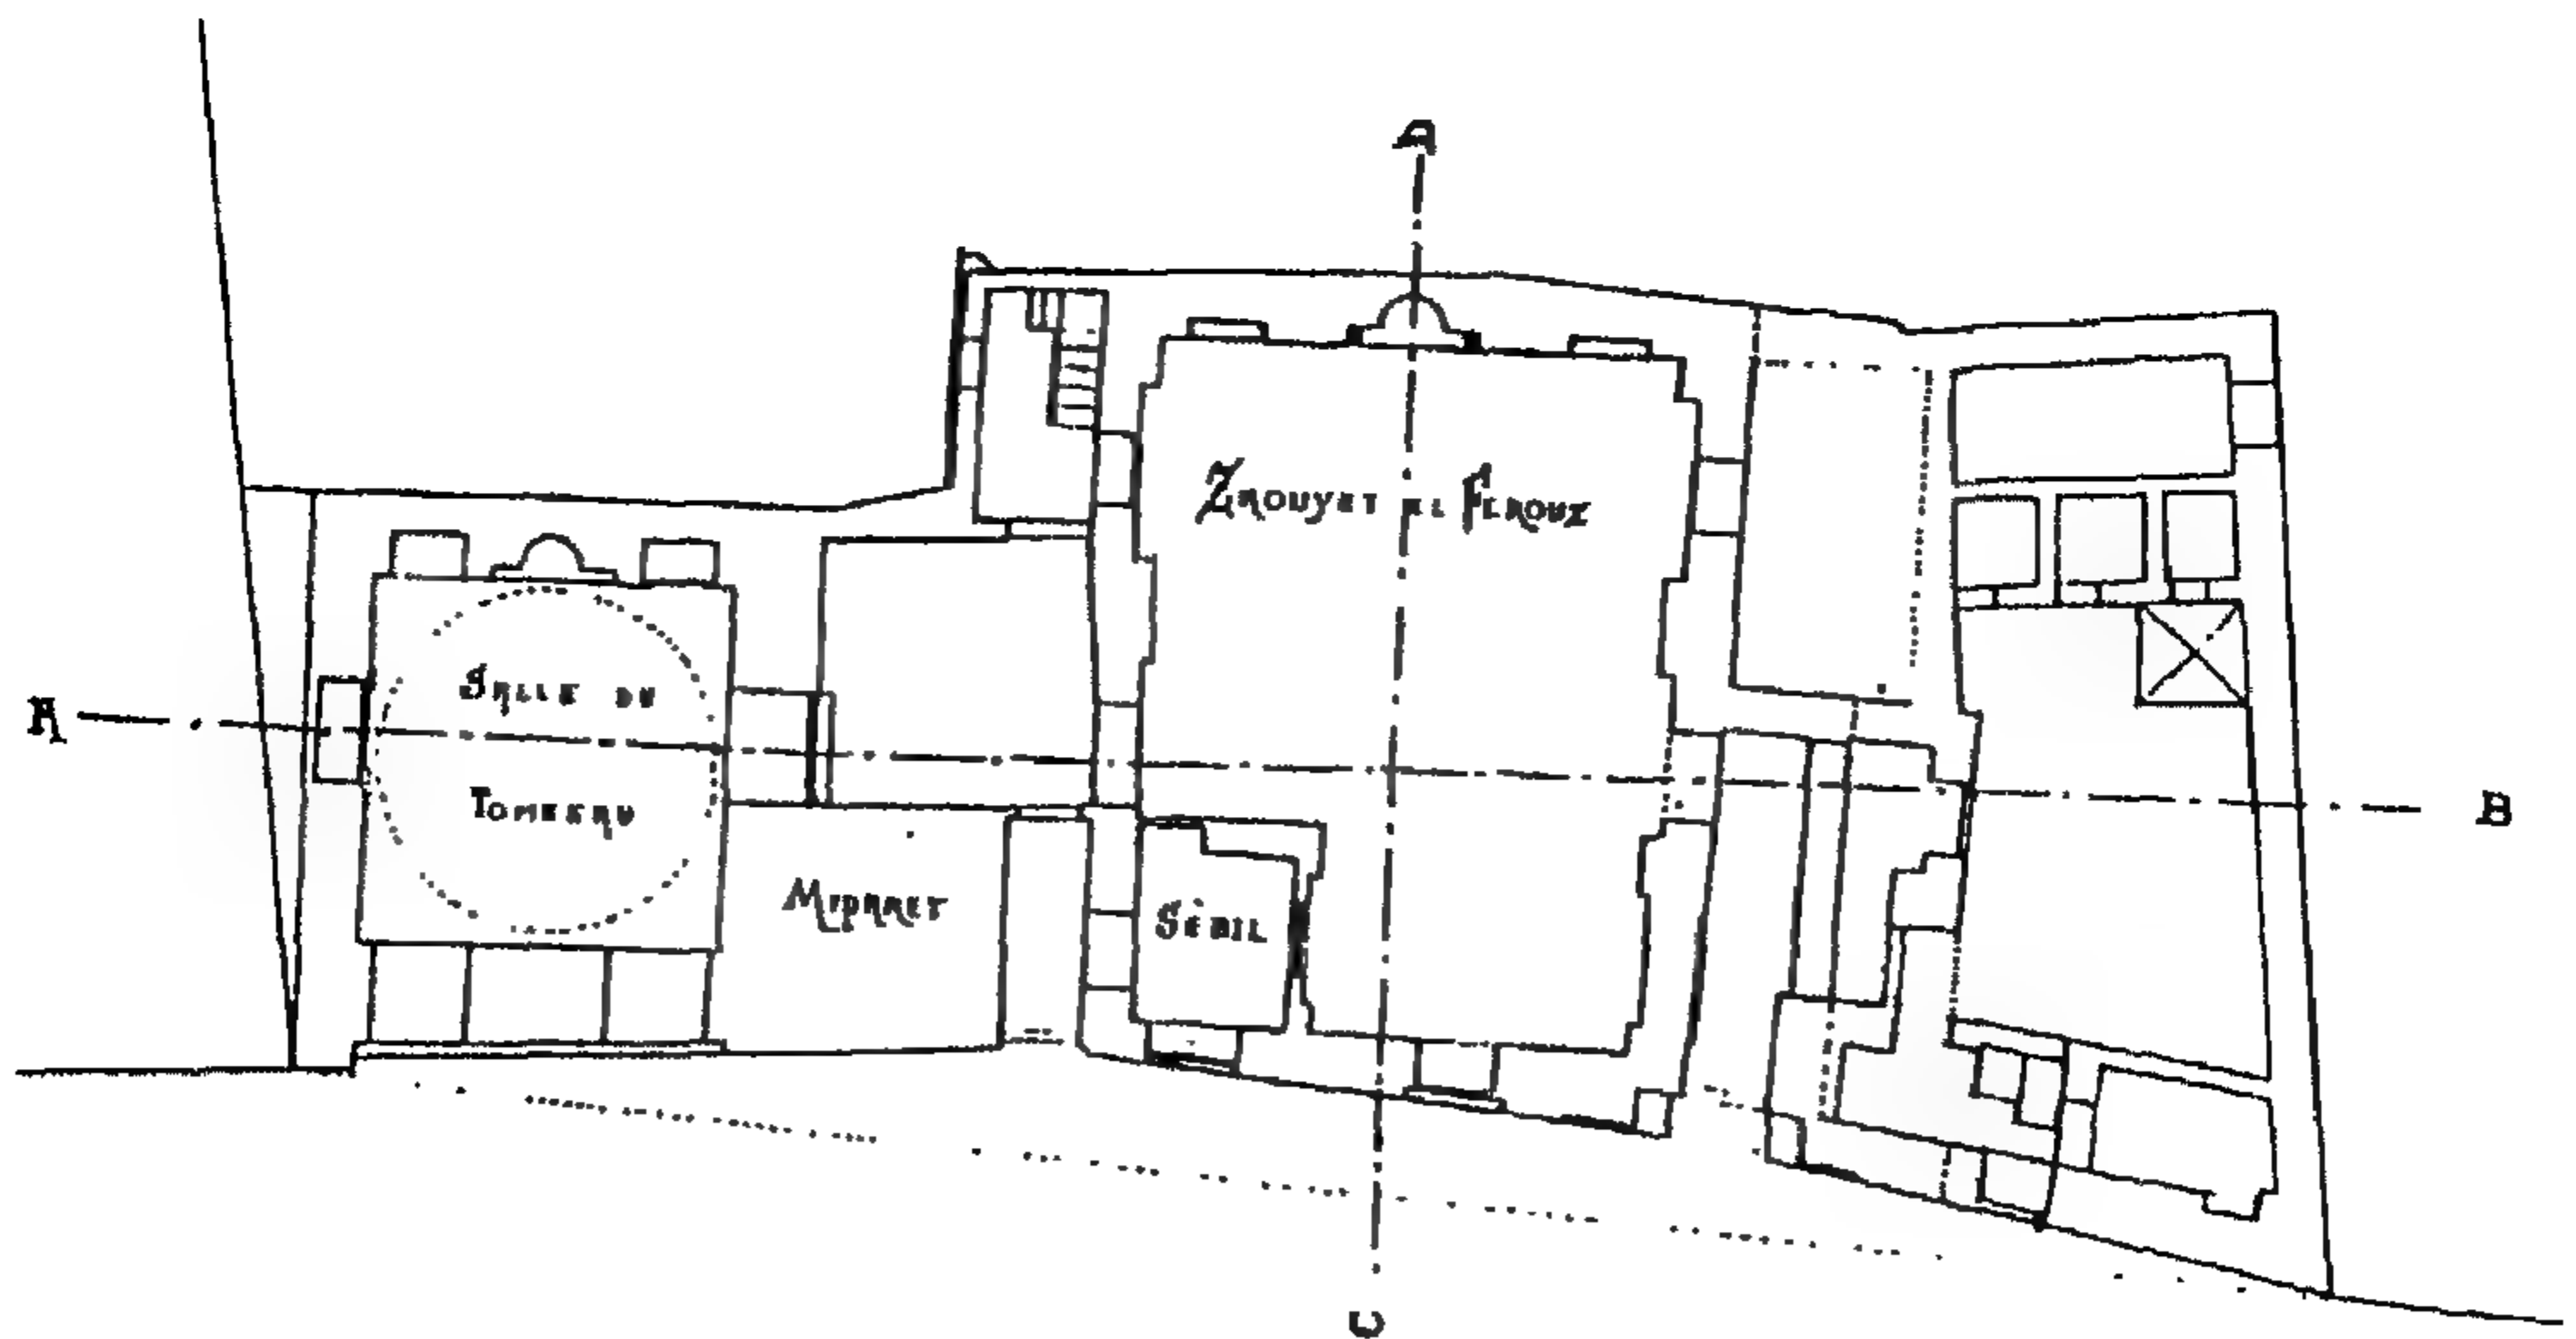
مسقط أفقي لمسجد مصطفى بك بن بنت
